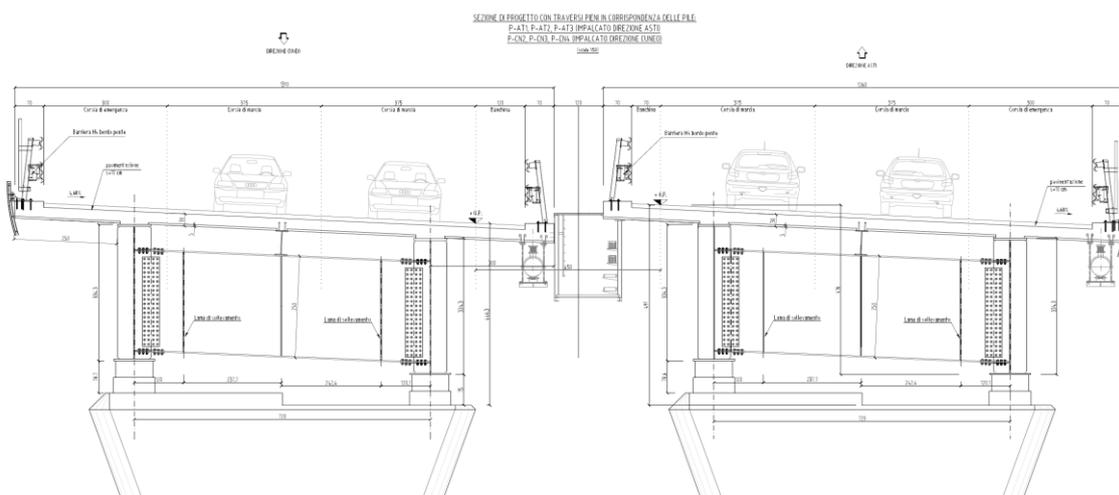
Sezione trasversale su appoggi delle campate lunghe
